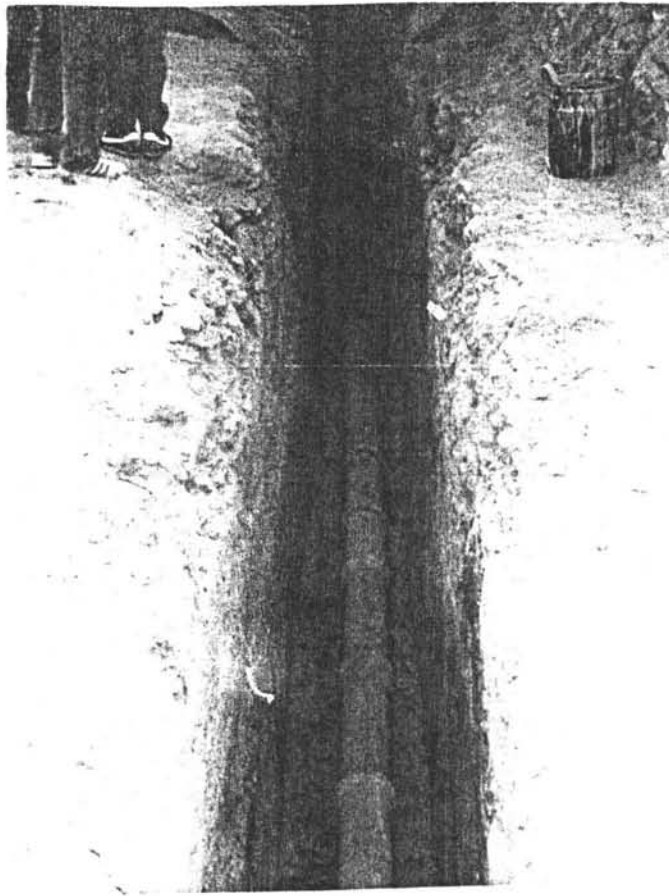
Tendido de tubería de 10cm de diámetro para el drenaje del muro de Suelo-Cemento.
